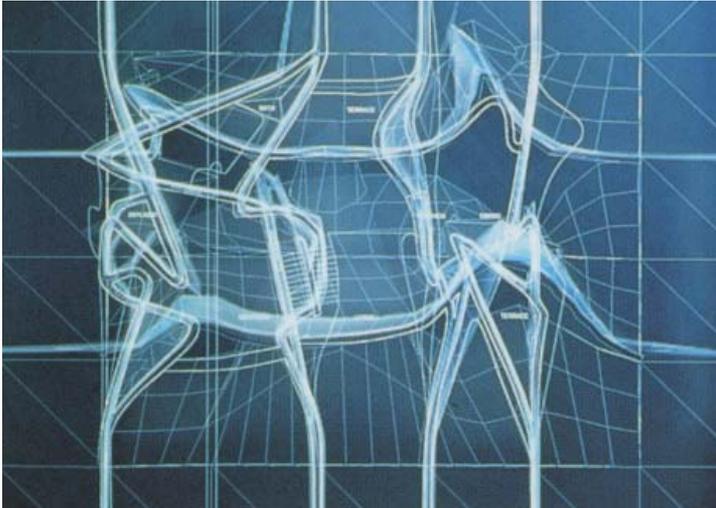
,24: Das virtual house, Grundriss OG, Querschnitt (Eisenman, 1997)
